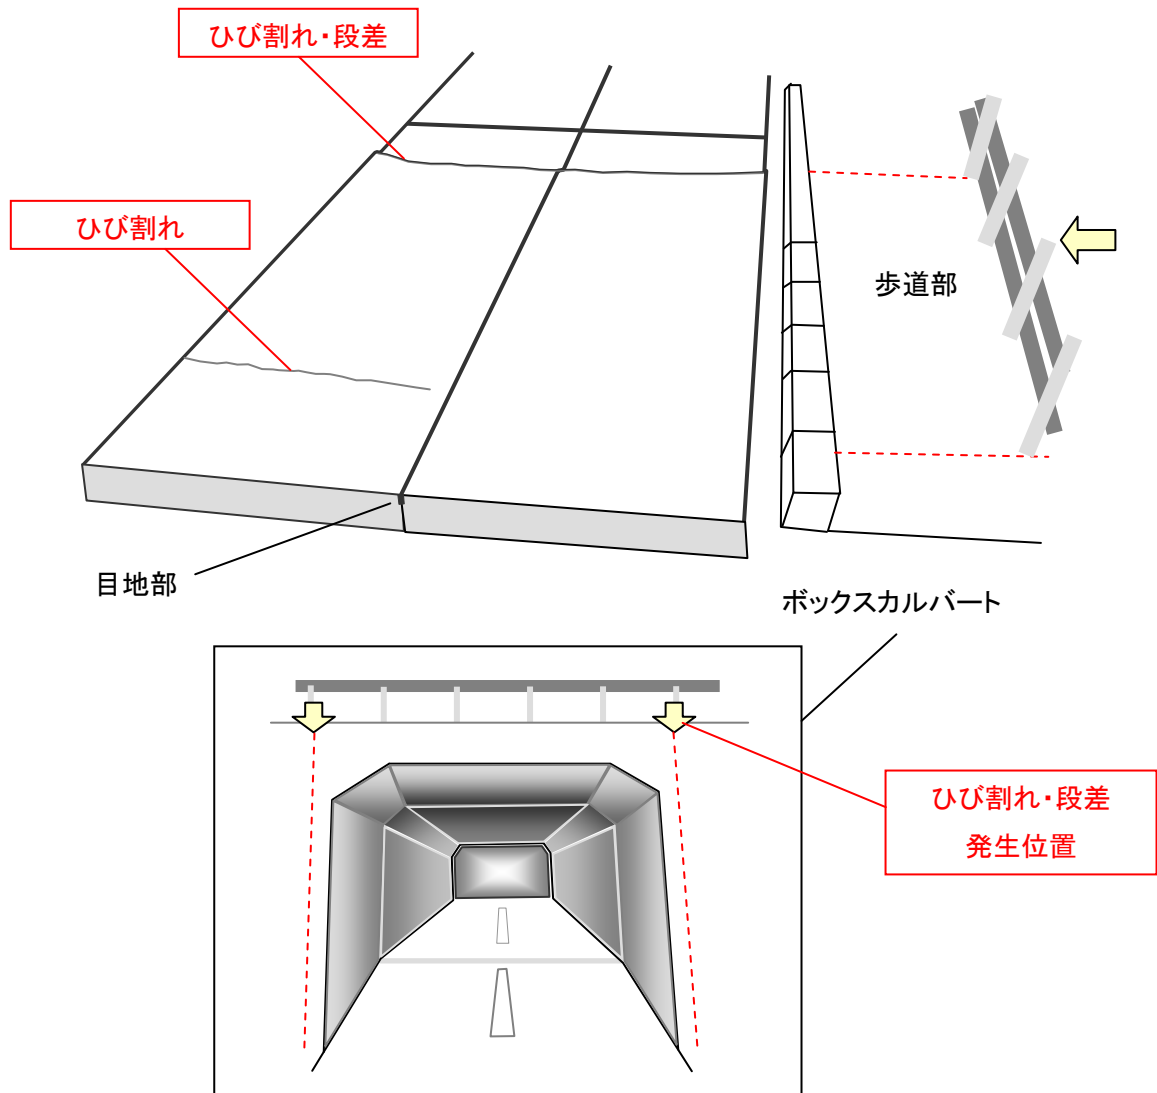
地下埋設構造物周辺のひび割れ・段差のイメージ
